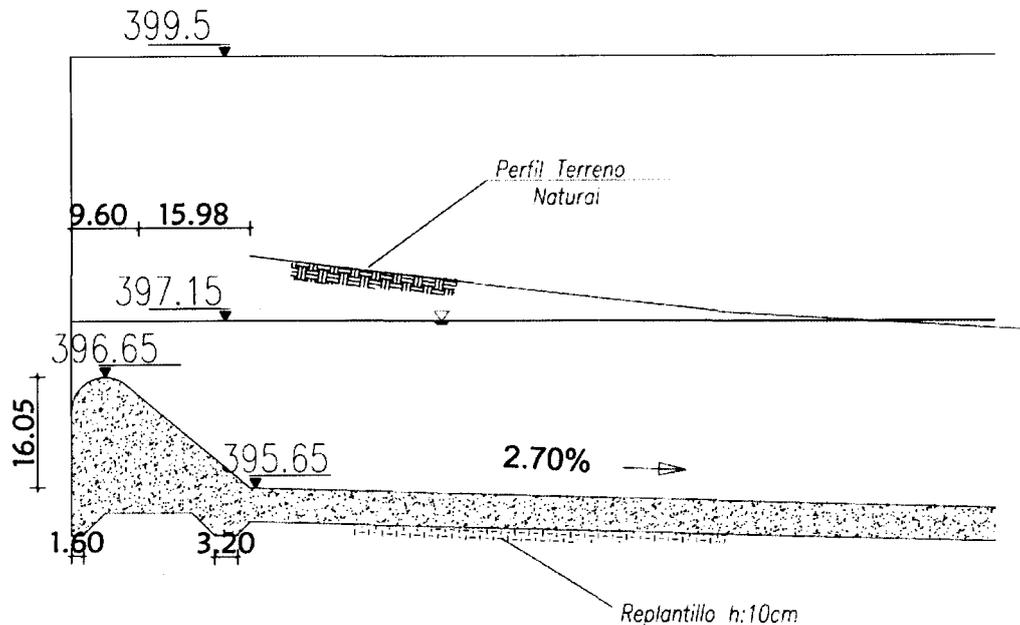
Detalle del aliviadero de acuerdo a los planos suministrados por Hidrotambo, expediente #1403-2016, denominados Planos As Built. No se observan obras de disipación en el plano de detalle, al igual que en el sitio de proyecto.
